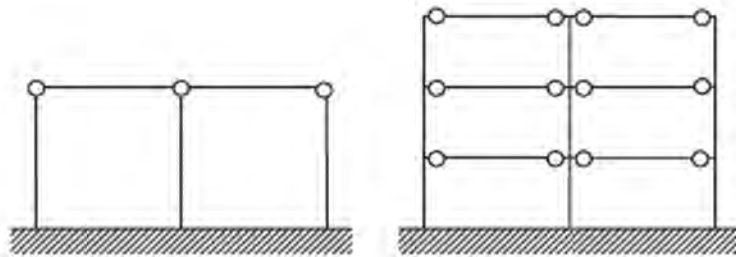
Strutture con pilastri incastrati alla base ed orizzontamenti ad assi cernierati
